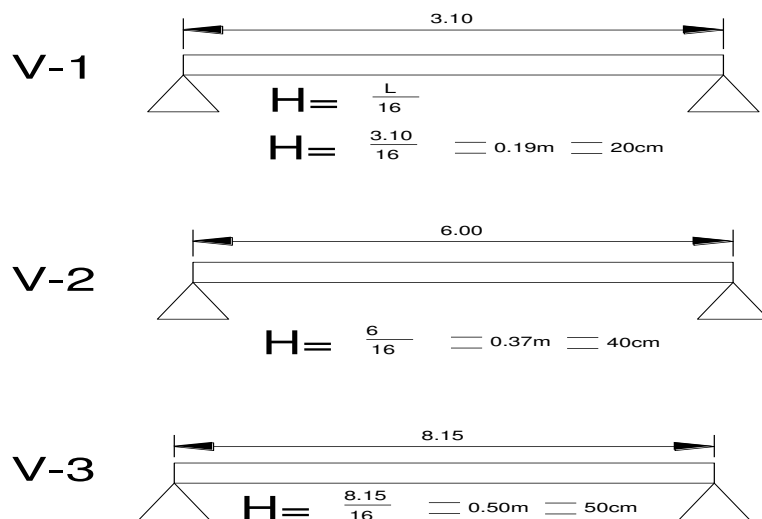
Predimensionamiento de vigas estructurales elaborado por el autor,ETM
